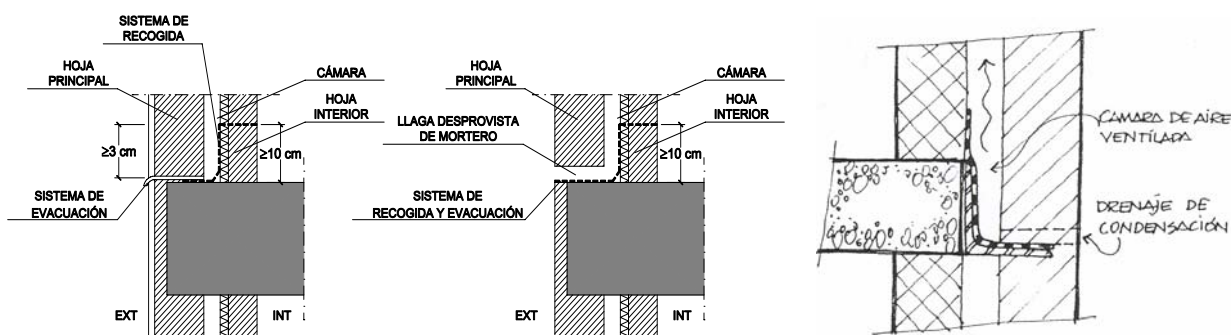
Encuentro con cámara de aire ventilada; propuesta del CTE y propuesta alternativa
